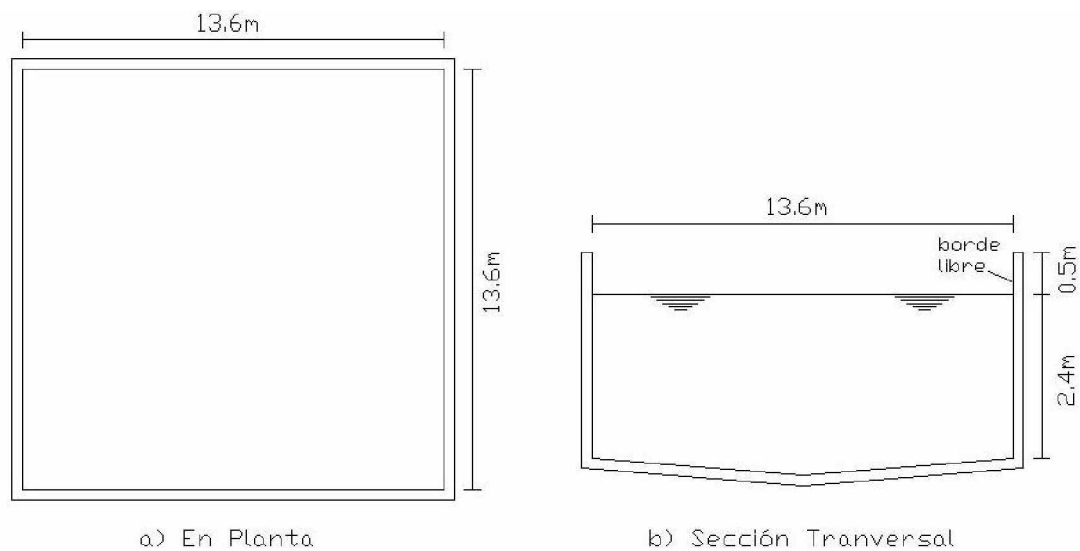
Esquemas del filtro percolador de la Planta N°3
